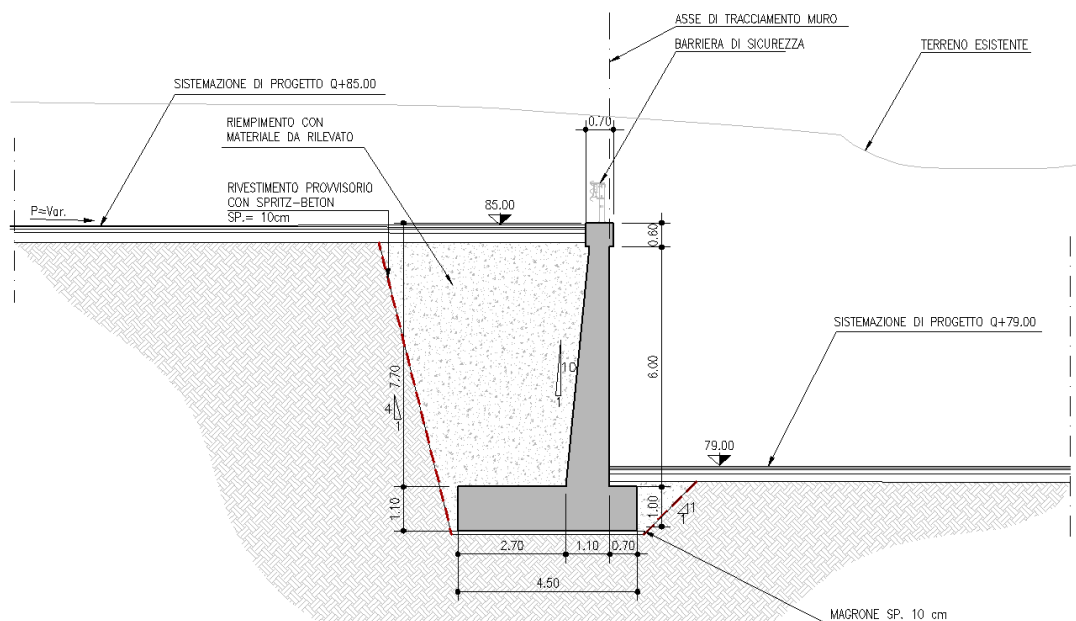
Muro di sostegno MS02 – Sezione tipo 1
